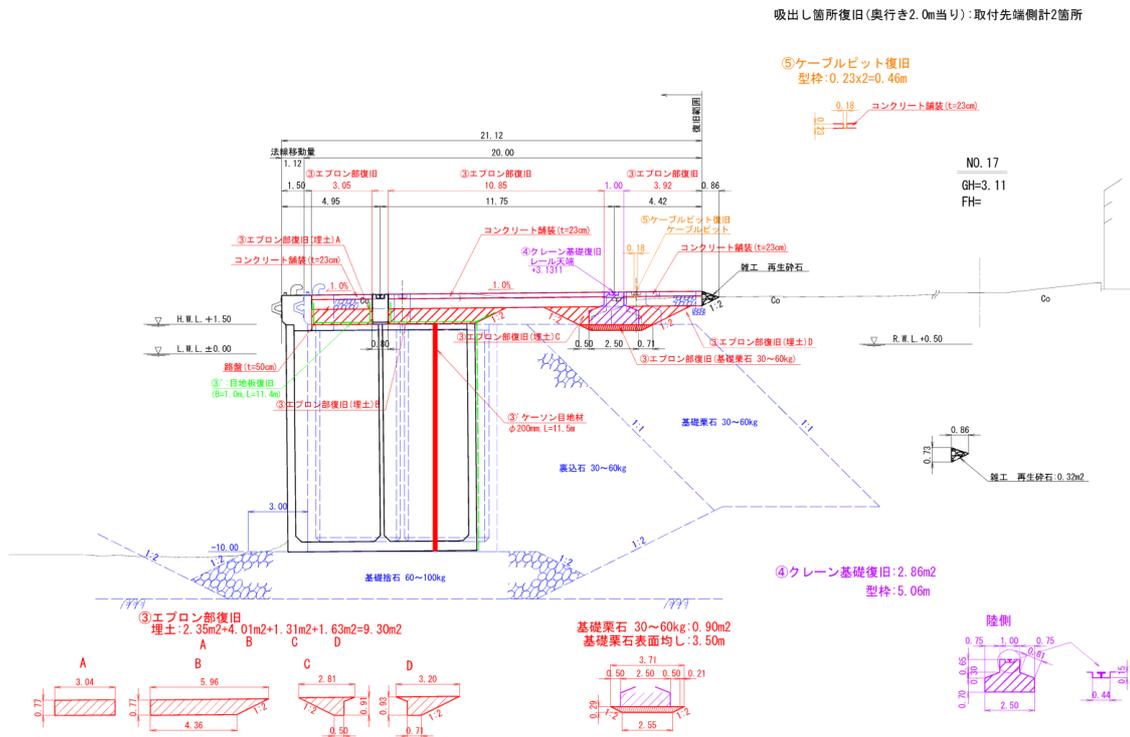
No.4 日立港区_第1ふ頭地区 1-D 岸壁 (-10.0m) の断面図 (吸出し箇所) (復旧後)
